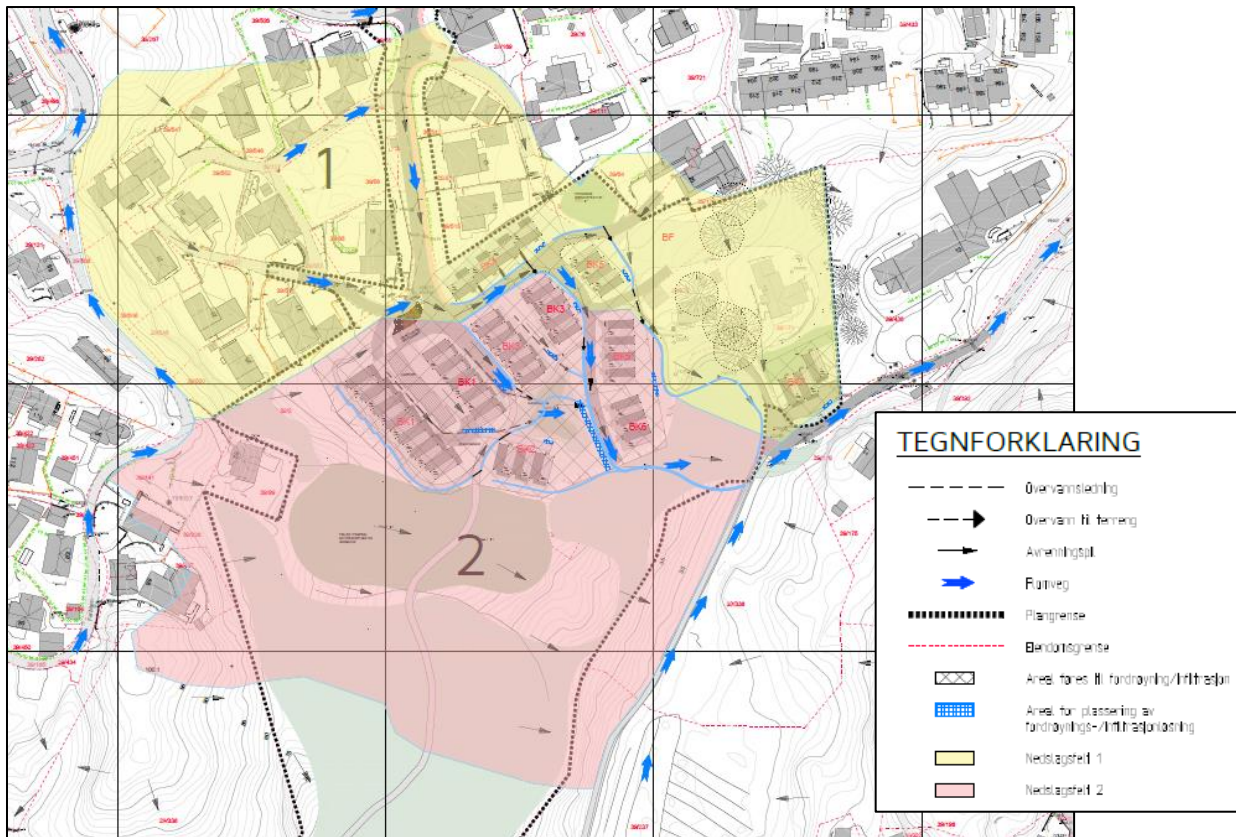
Utsnitt fra VA-rammeplan (2024) tegning nr. 004.
